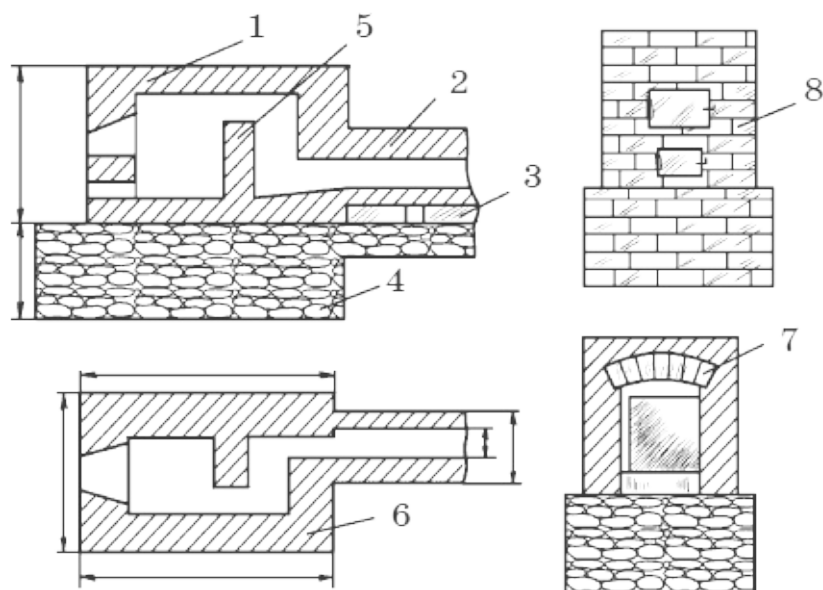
Тепличная печь: 1 — печь; 2 — дымоход; 3 — шанцы; 4 — фундамент; 5 — перегородка в полкирпича; 6 — стенка в один кирпич; 7 — выстилка в два ряда; 8 — фасад
